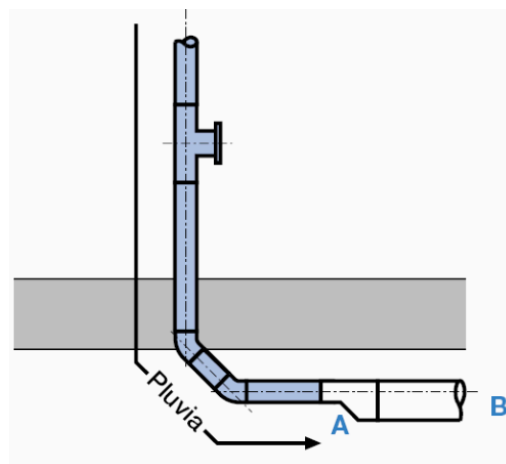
Aumento do diâmetro depois da laje de pavimento, [12]
